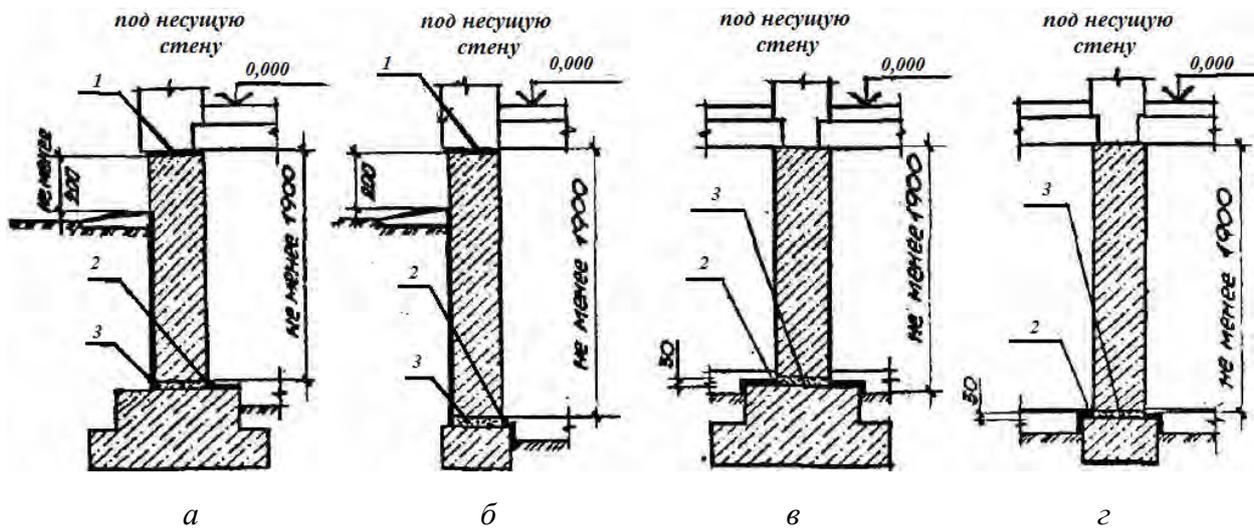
Монолитные фундаменты в зданиях с подвалом: а, б — под наружные стены; в, г — под внутренние стены: 1 — два слоя толя на битумной мастике; 2 — окраска горячим битумом (2 раза); 3 — цементный раствор
